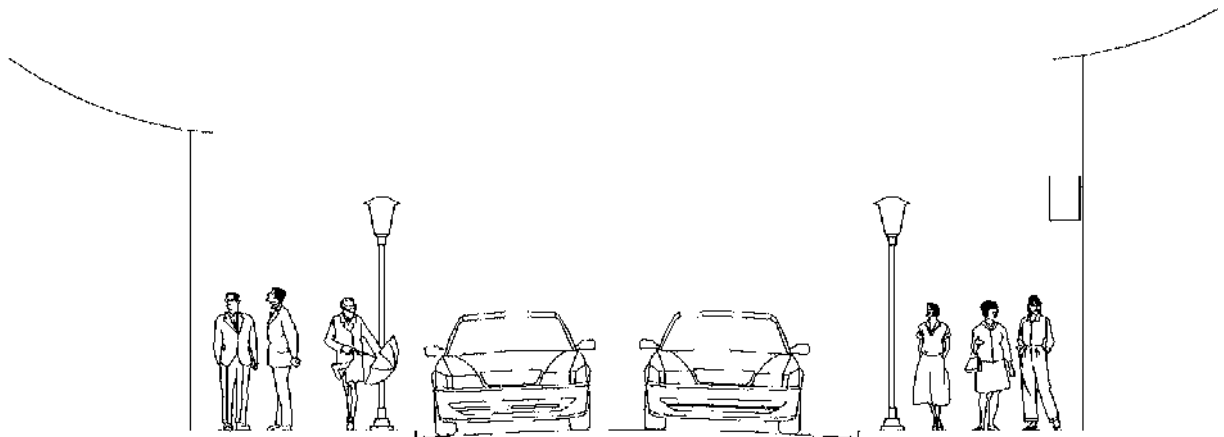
Corte esquemático da proposta para a Rua da Paz.
